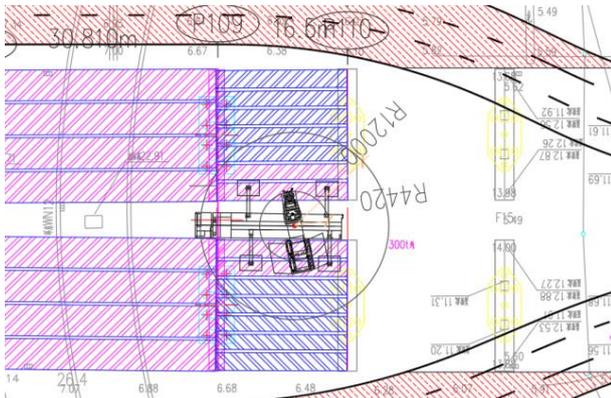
P109-110 双 T 梁汽车吊吊装工况平面图
